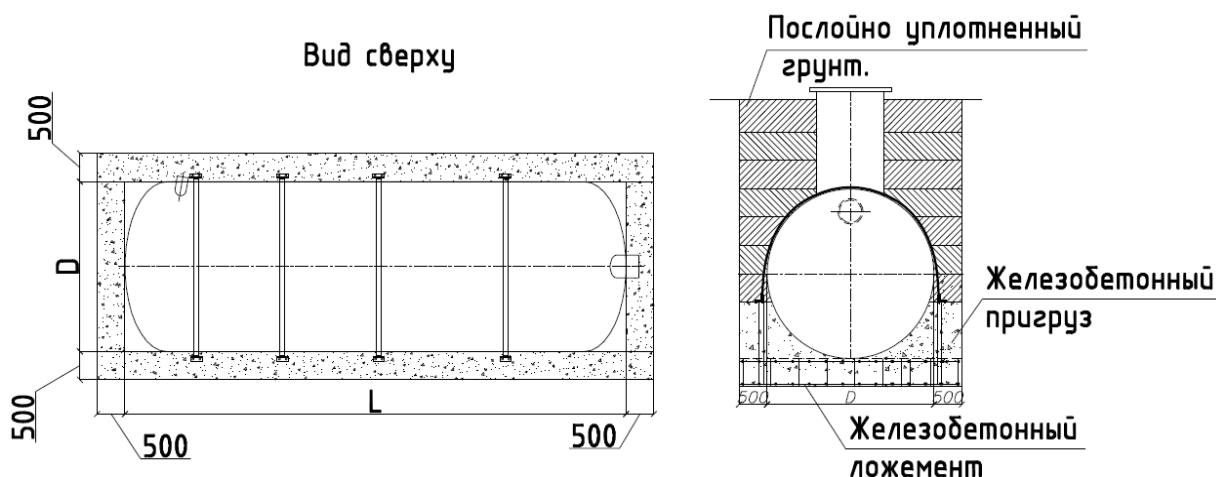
Пример монтажа оборудования при высоком уровне грунтовых вод.
